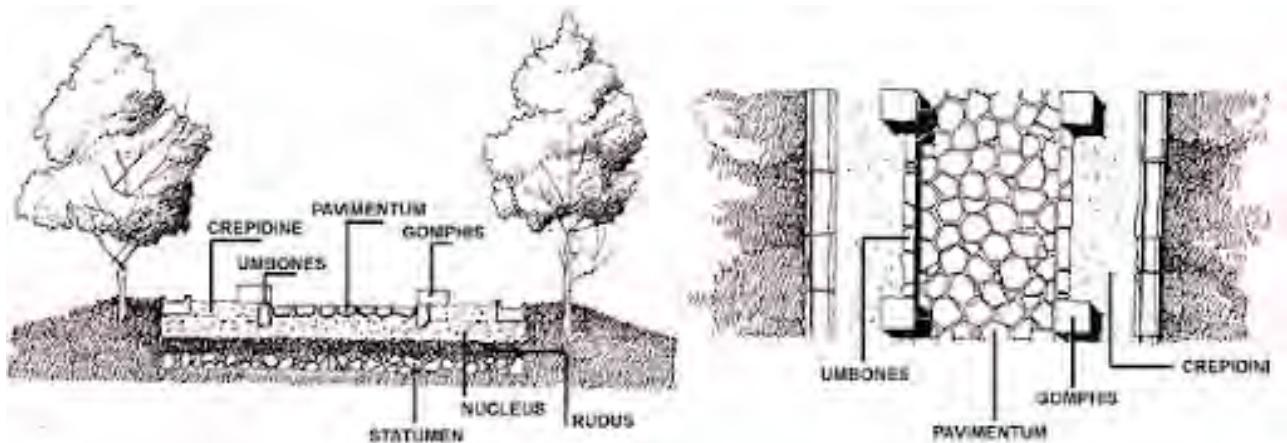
Sección de una calzada romana, detalles constructivos (Fuente: Romanoimperio).
